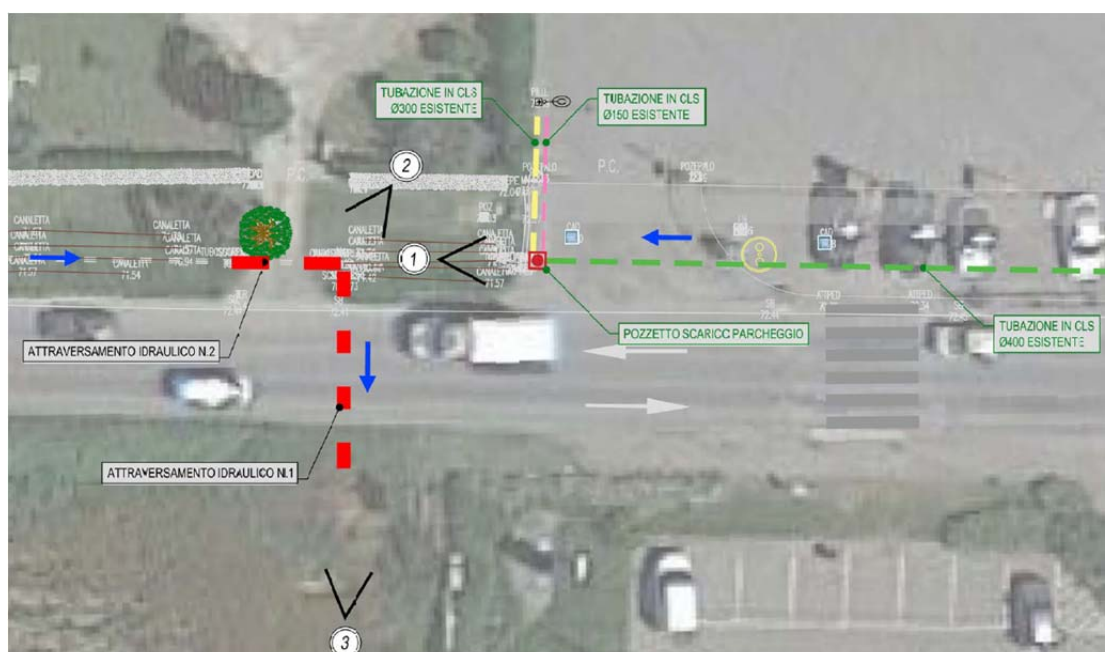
Estratto planimetrico attraversamento n.1 e n.2
